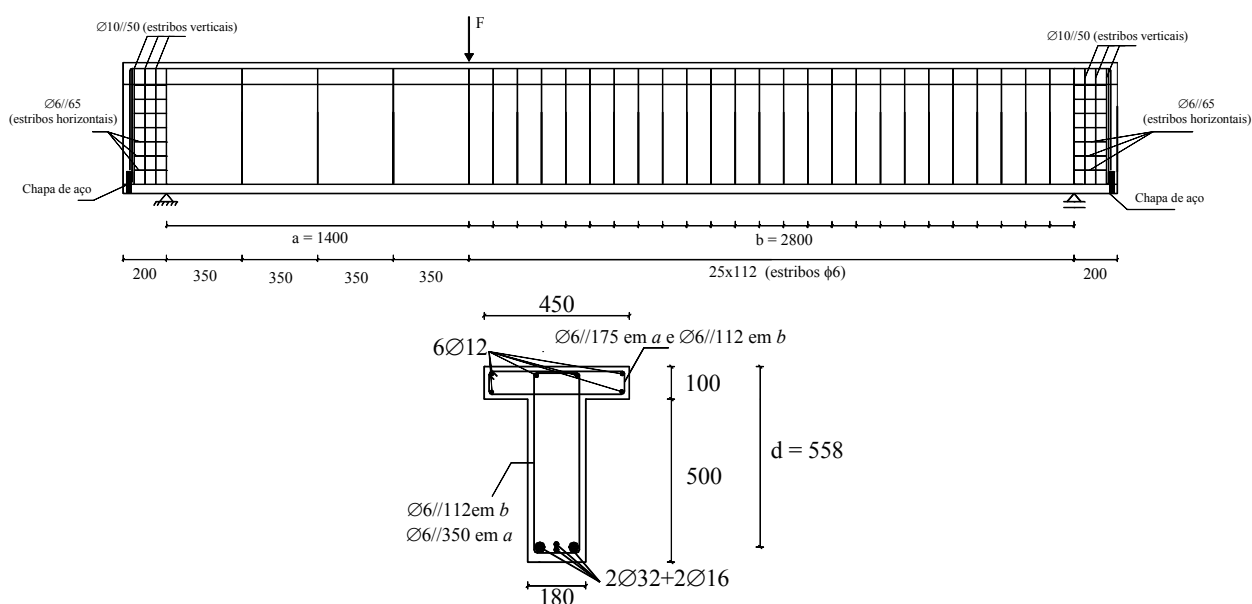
Geometria das vigas a ensaiar (dimensões em mm).
